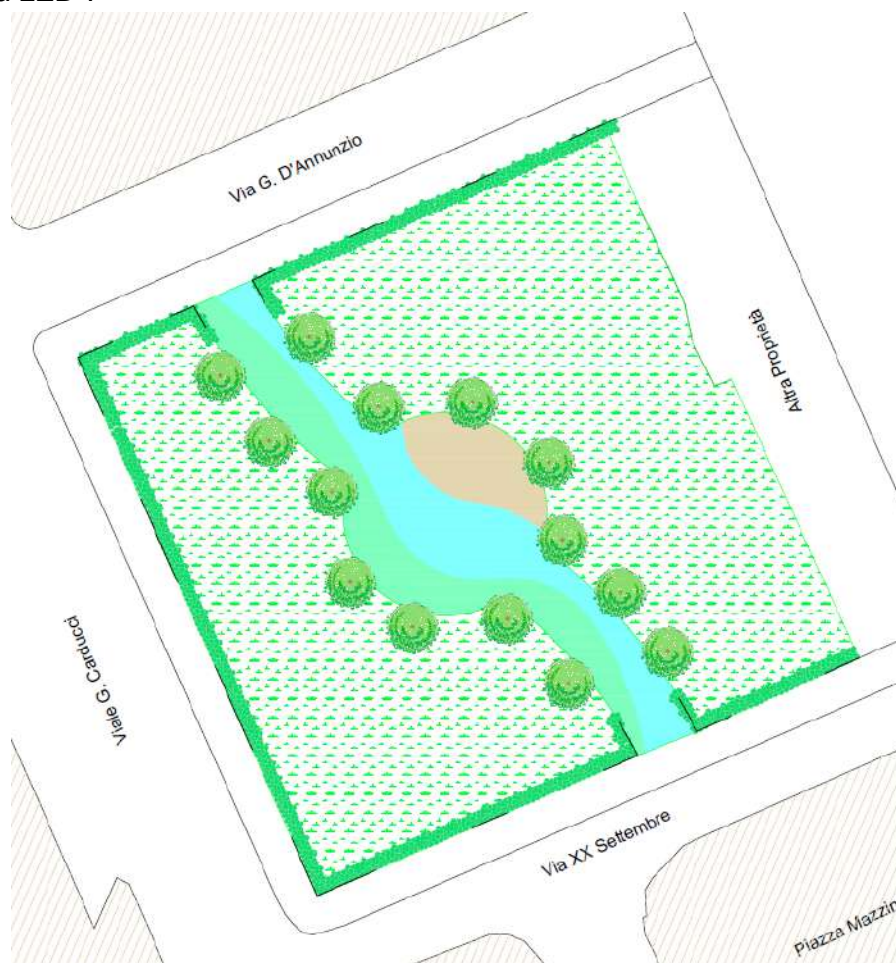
Estratto da "Planimetria generale stato di progetto" allegata alla D.C.C. n. 68/2022
